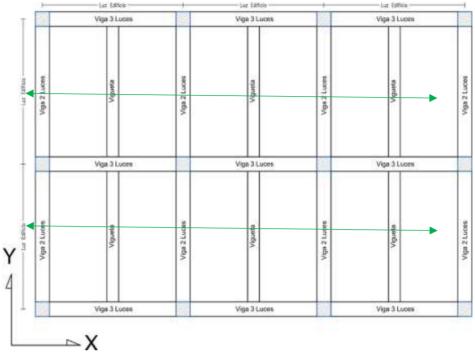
Esquema estructural para edificaciones con luces de 5 hasta 9 metros.
